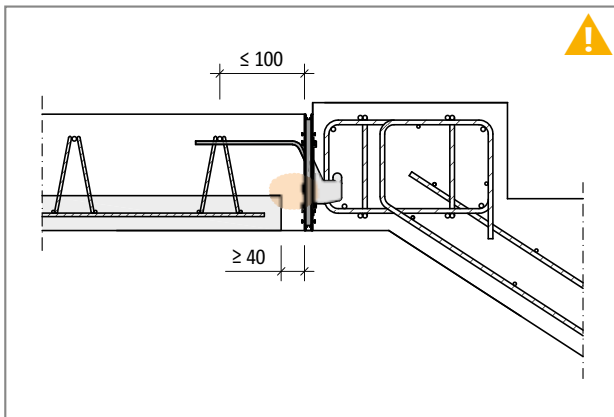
Schöck Tronsole® Typ T: Einbau in Verbindung mit Elementdecken, Druckfuge deckenseitig
